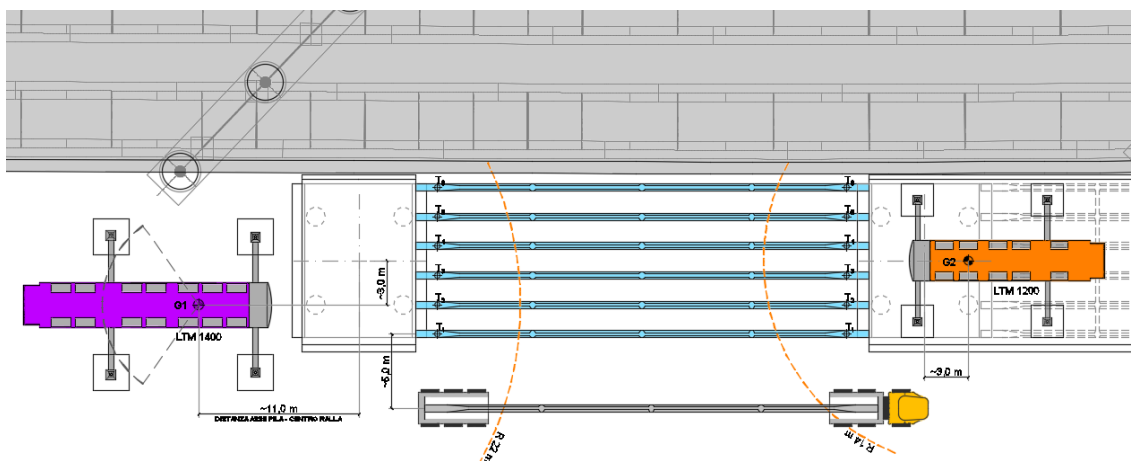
Piazzamento mezzi di sollevamento campata tipologica
